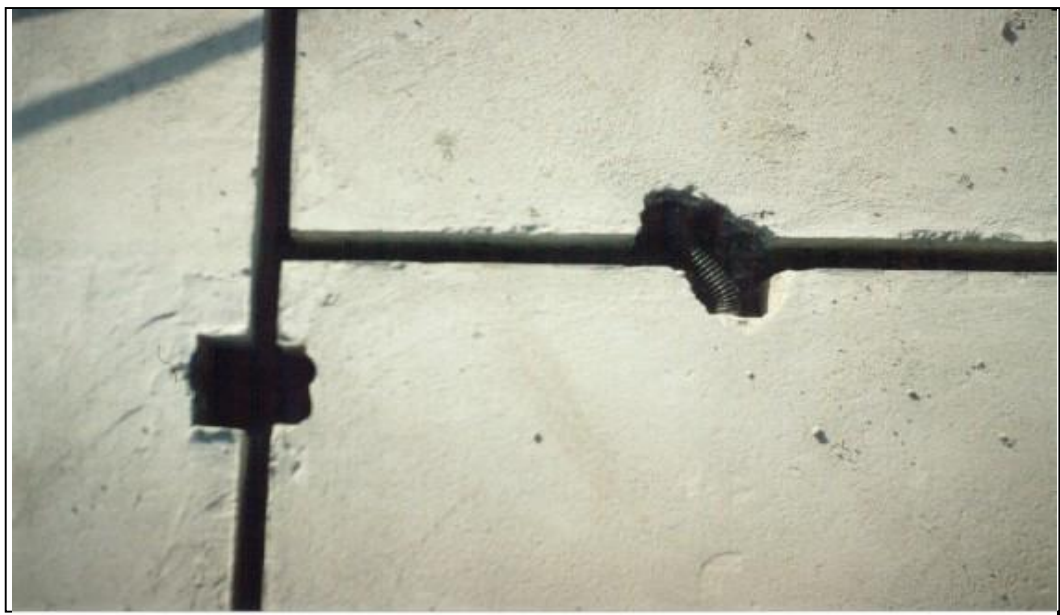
Lajes pré-moldadas maciças com recortes para ligação entre eletrodutos.
